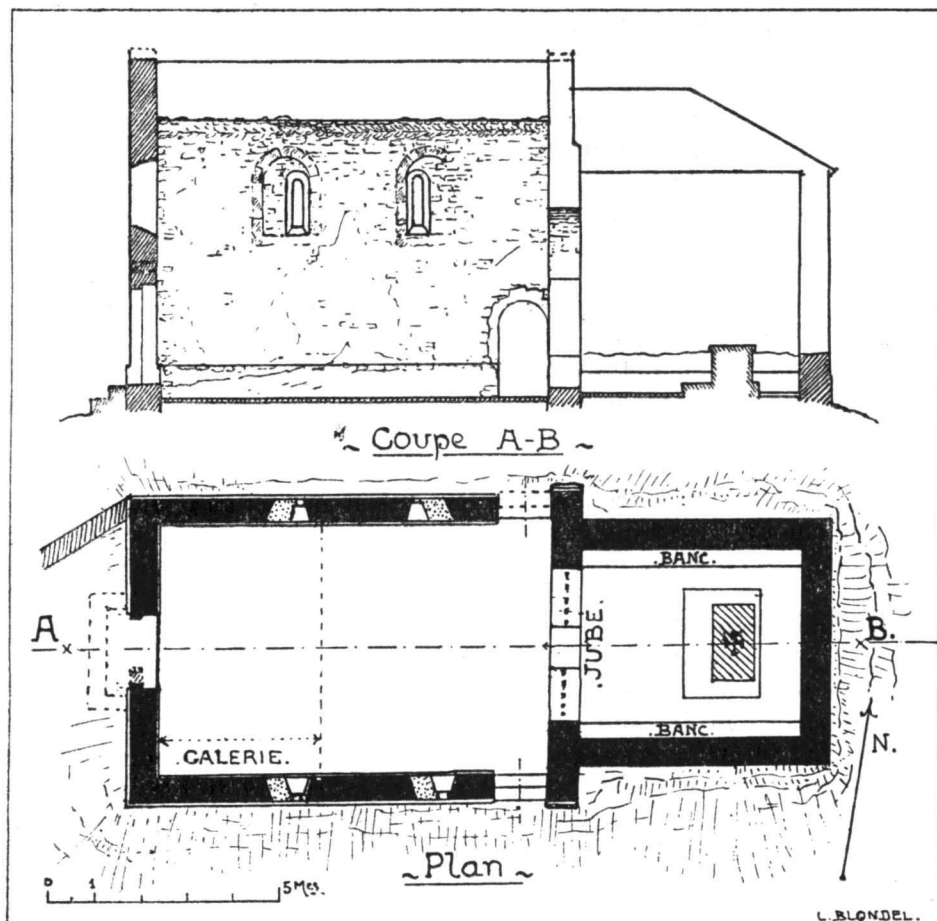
Plan et coupe de la chapelle St-Félix à Géronde.
